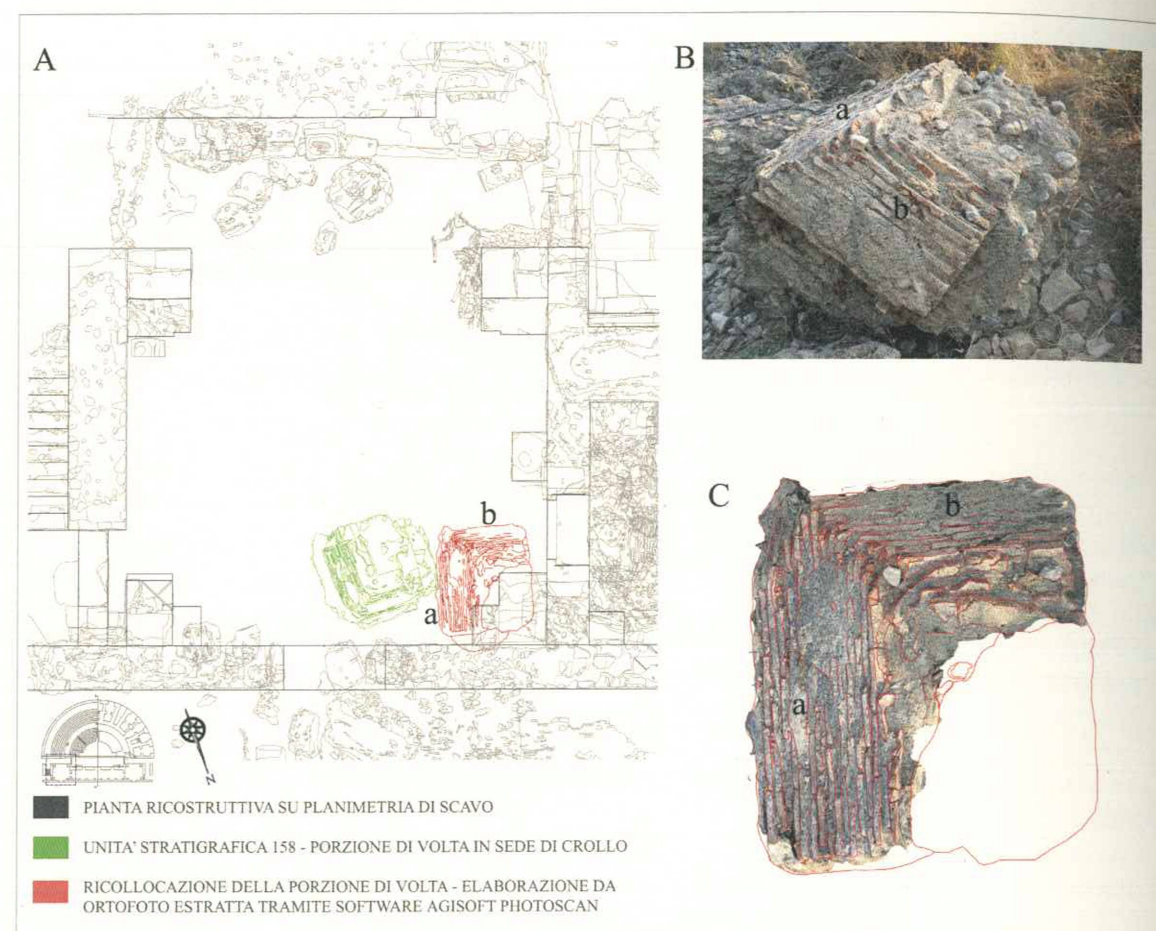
A) Planimetria di scavo con pianta ricostruttiva, identificazione dell'unità stratigrafica 158 (in verde) e sua ricollocazione nella configurazione originaria (in rosso); B) Fotografia della porzione di volta oggetto di analisi; C) Ortofoto estratta da software Agisoft PhotoScan e restituzione grafica bidimensionale in ambiente cad.
